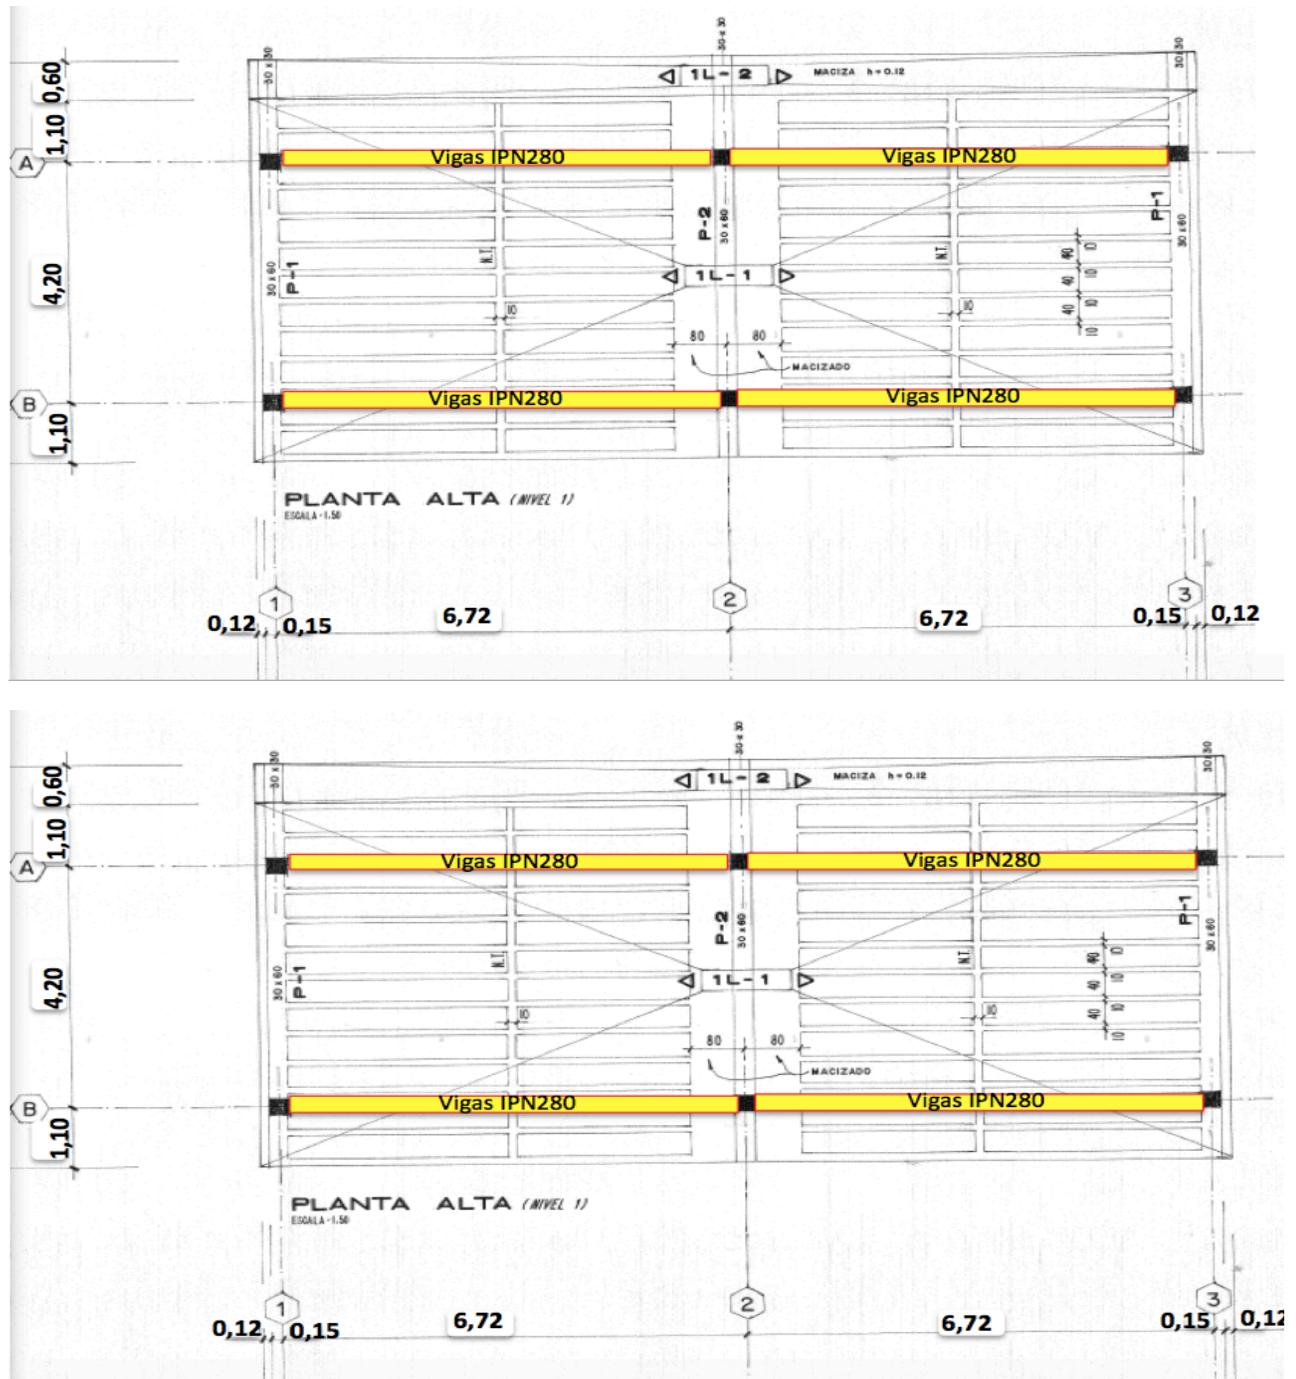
Ubicación de la viga de refuerzo. (Fuente propia)
